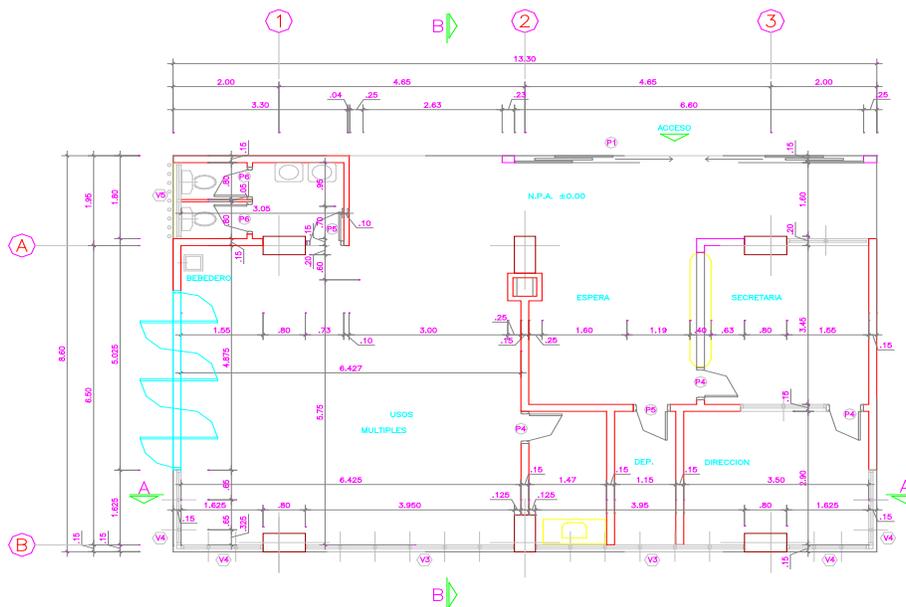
Plano de Planta Baja, Sistema Constructivo “Módulo de Barrio”
